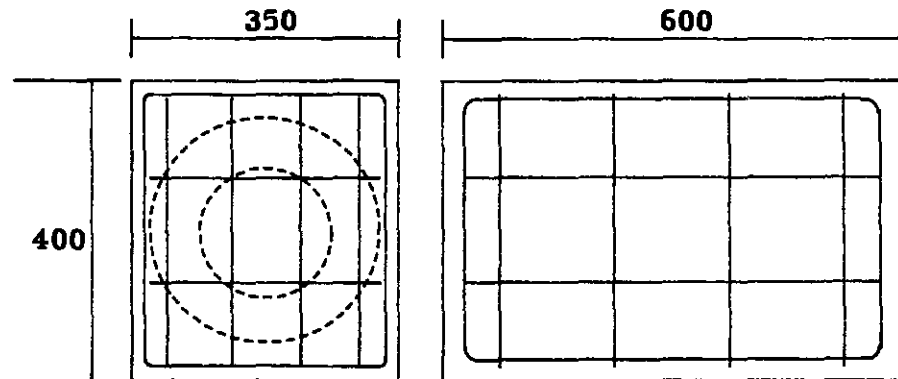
DETALHES DAS ARMADURAS TRANSVERSAL E DO BLOCO CENTRAL
